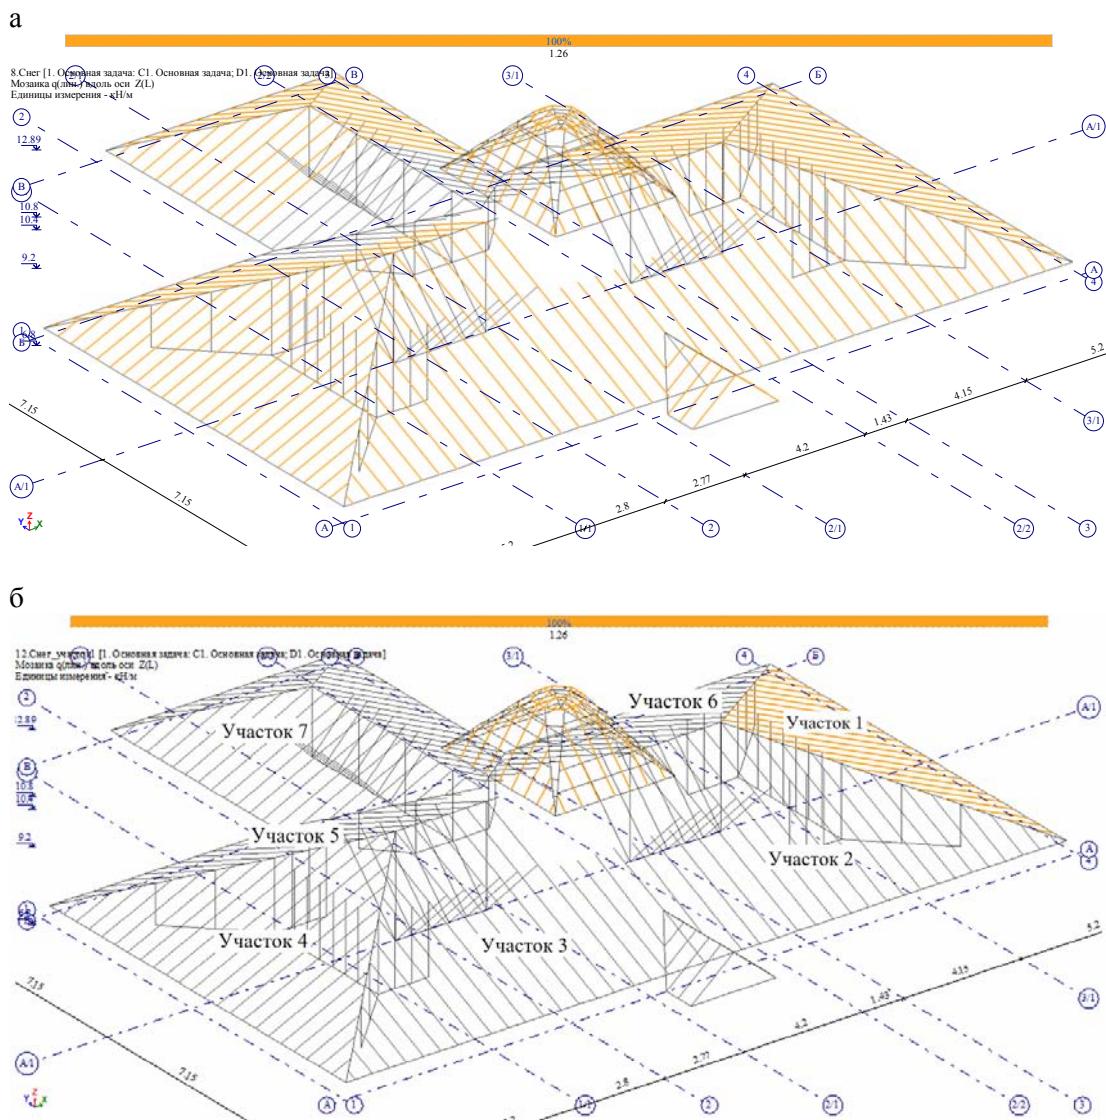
Варианты задания снеговой нагрузки на кровлю здания:
